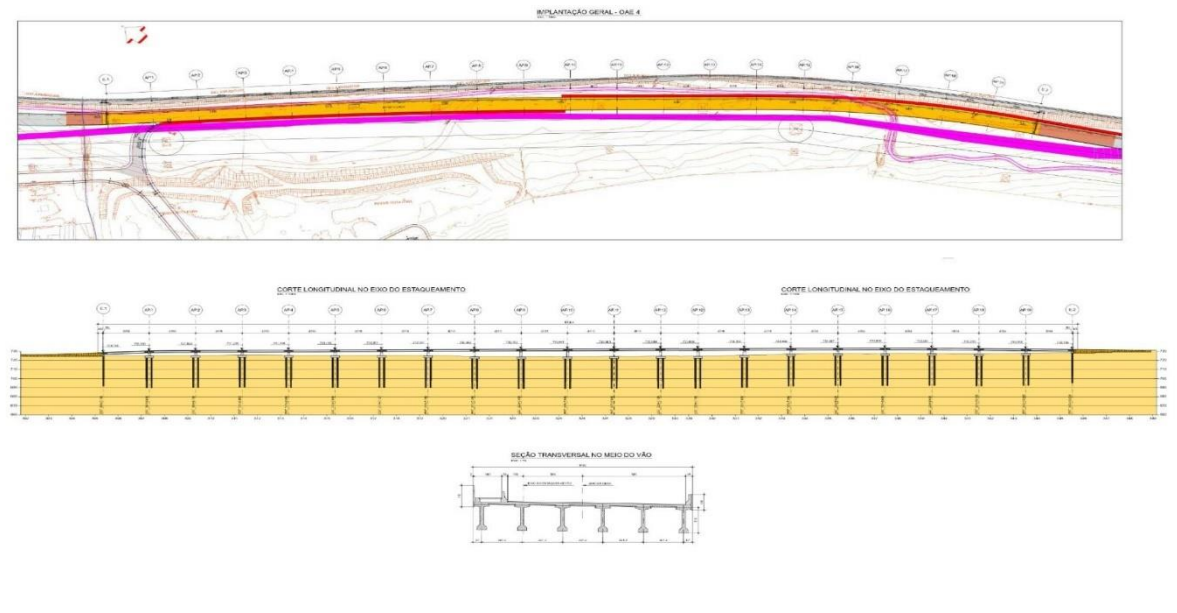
Trecho do elevado jurubatuba e perfil, objeto de intervenção.
